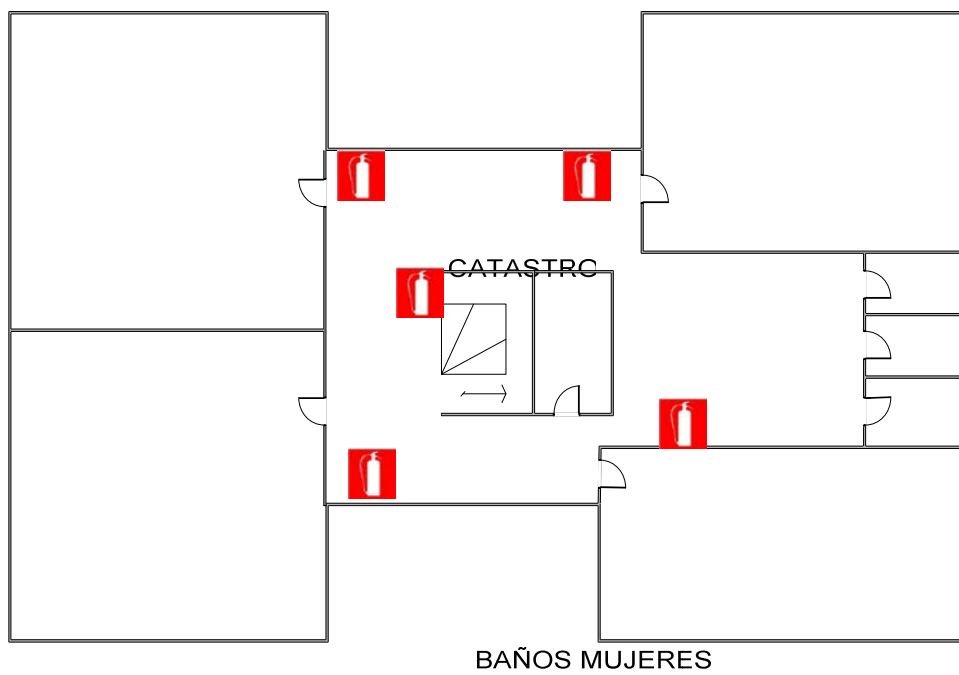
Plano de extintores 4to. nivel del edificio del MEM
